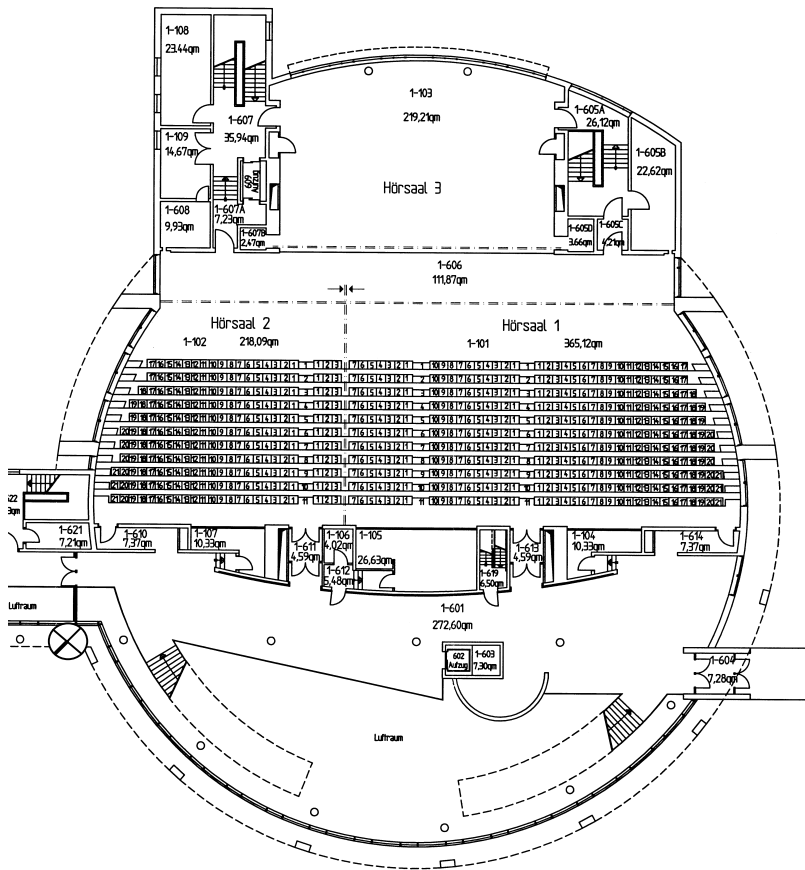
Grundriss OG (Maßstab ca. 1:400)
